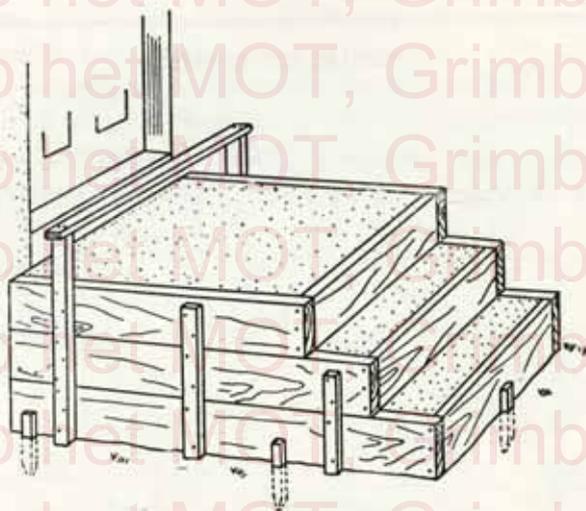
Coffrage simple pour construire un escalier en béton monolithe.
